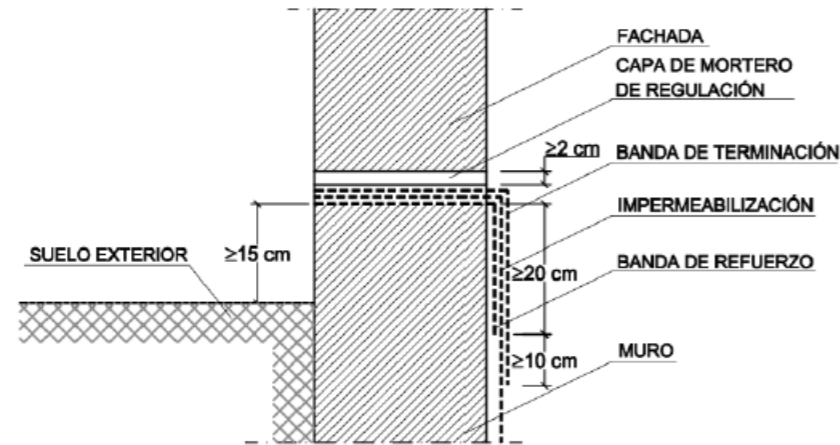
Ejemplo de encuentro de un muro impermeabilizado por el interior con lámina con una fachada
